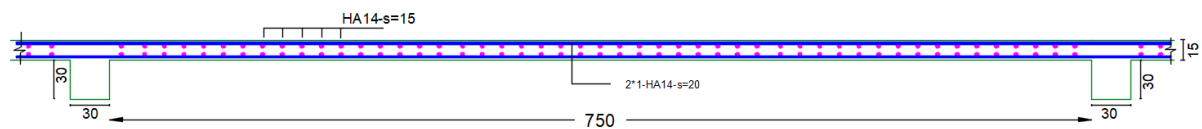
Ferrailage de la dalle (Coupe A-A).
